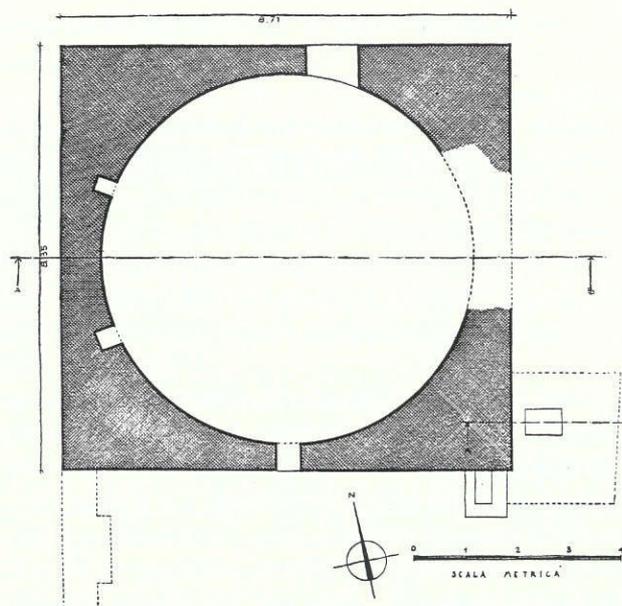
Noto, Contrada Falconara. Planimetria del rudere (da Agnello)
